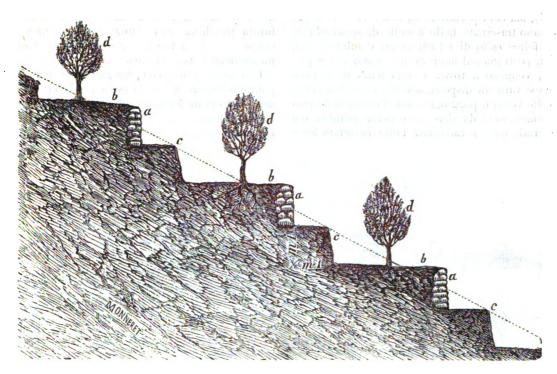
Disposizione del poggio ripido a terrazze con banchine (nel rapporto di 1:100).
